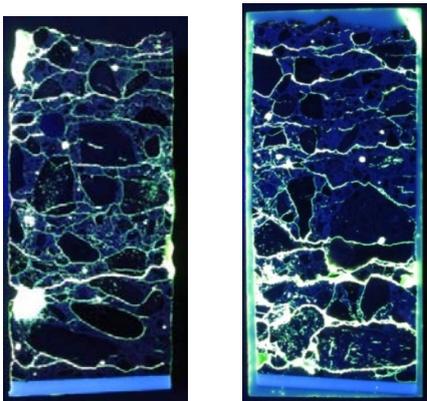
蛍光塗料含浸法によるコアのひび割れ (床版表面側が写真の上側)
